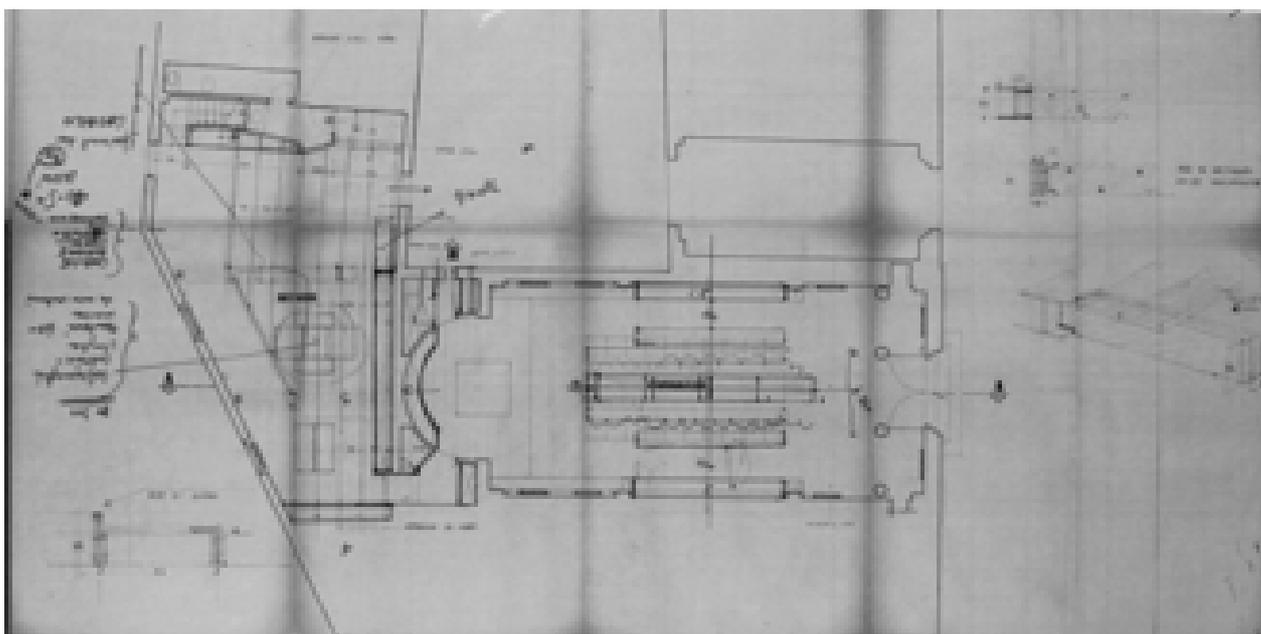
Pianta quota +0,00 – Stato di progetto – 24/02/1981 (AABS-94.045)
